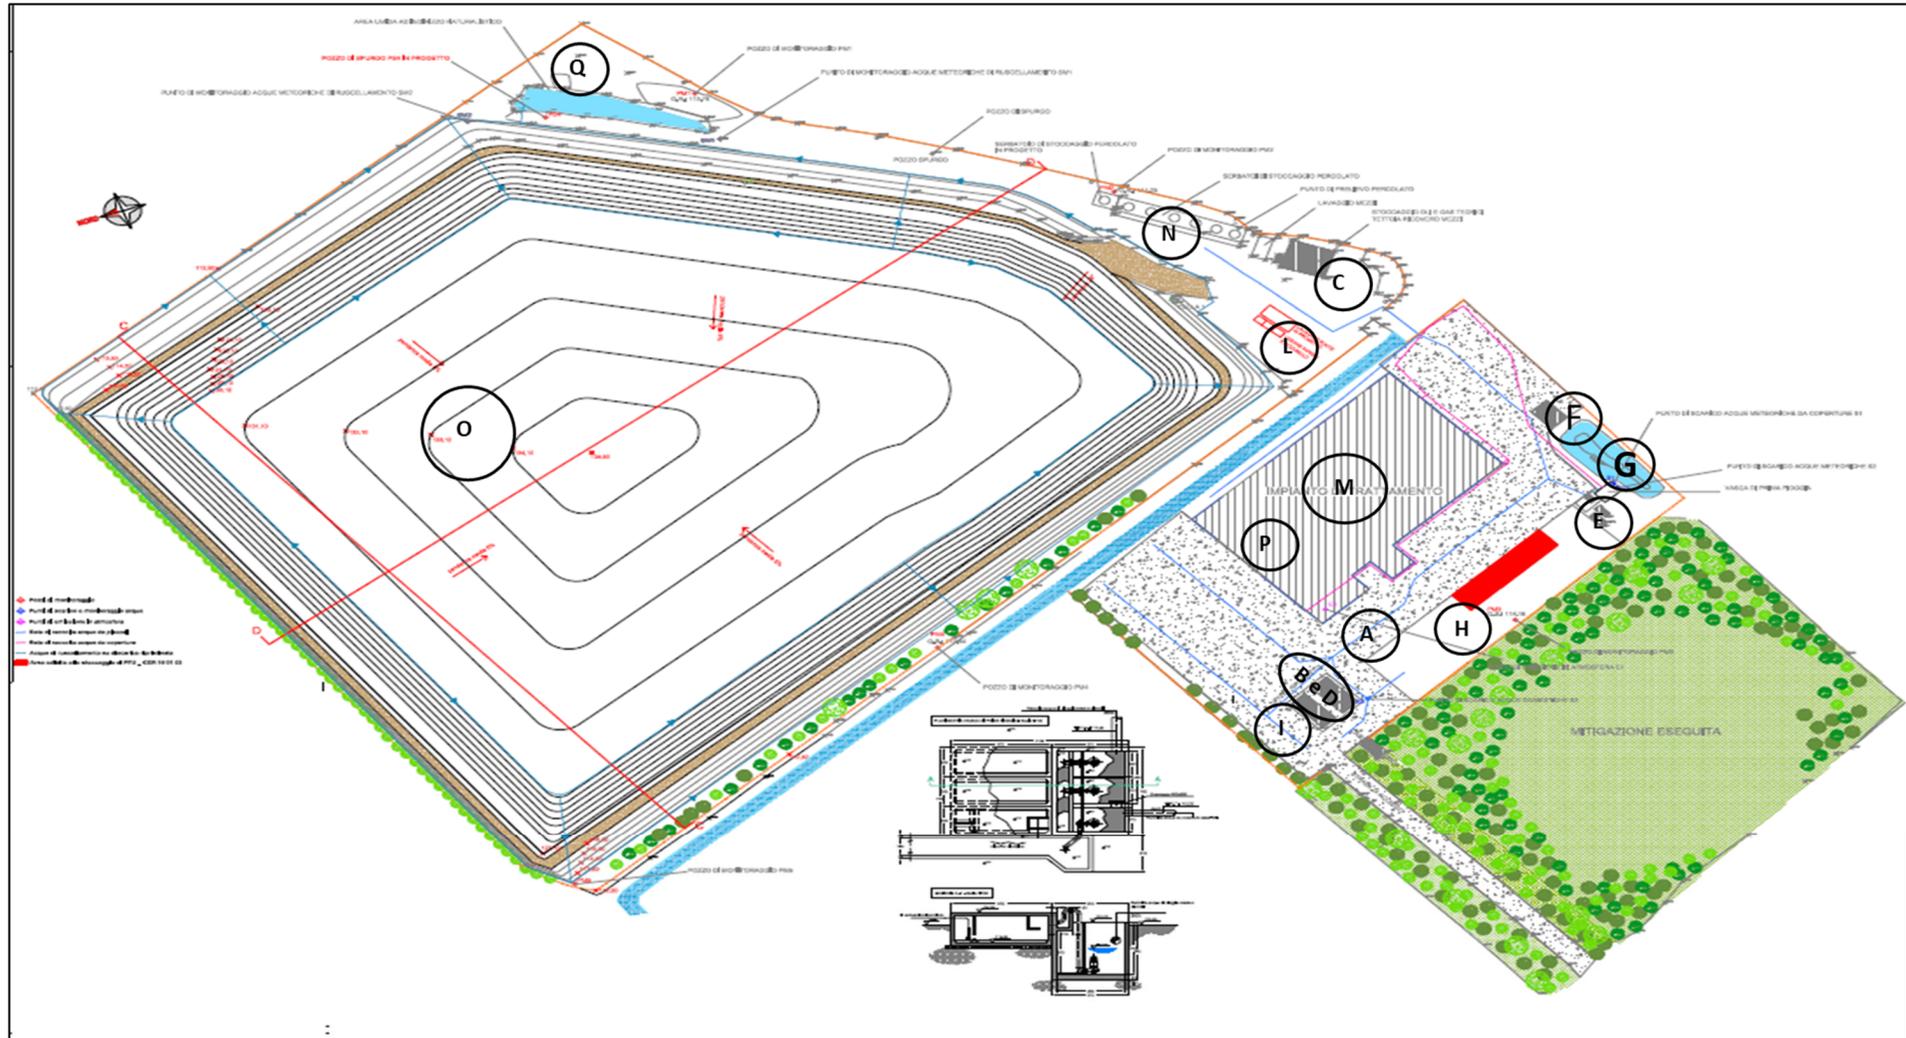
Sito di Albonese – Planimetria Stato Attuale
